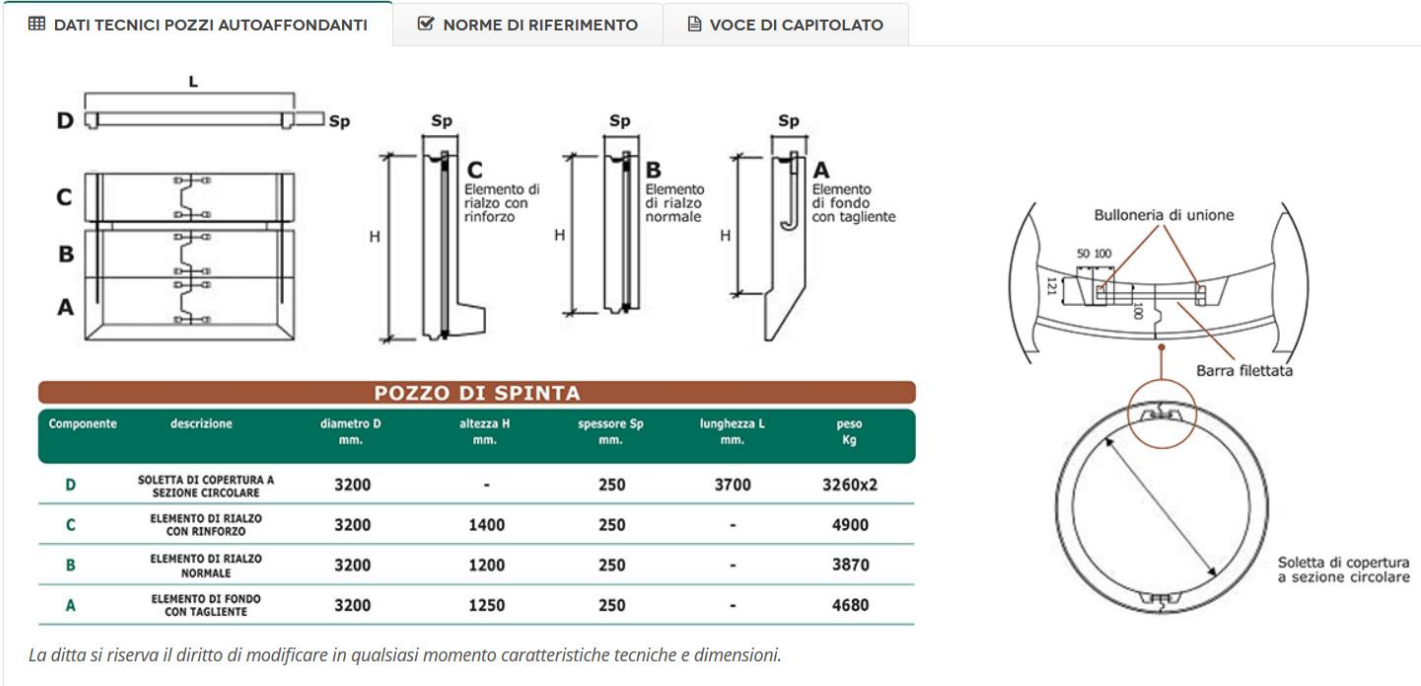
J : Specifica tecnica pozzo autoaffondante circolare
